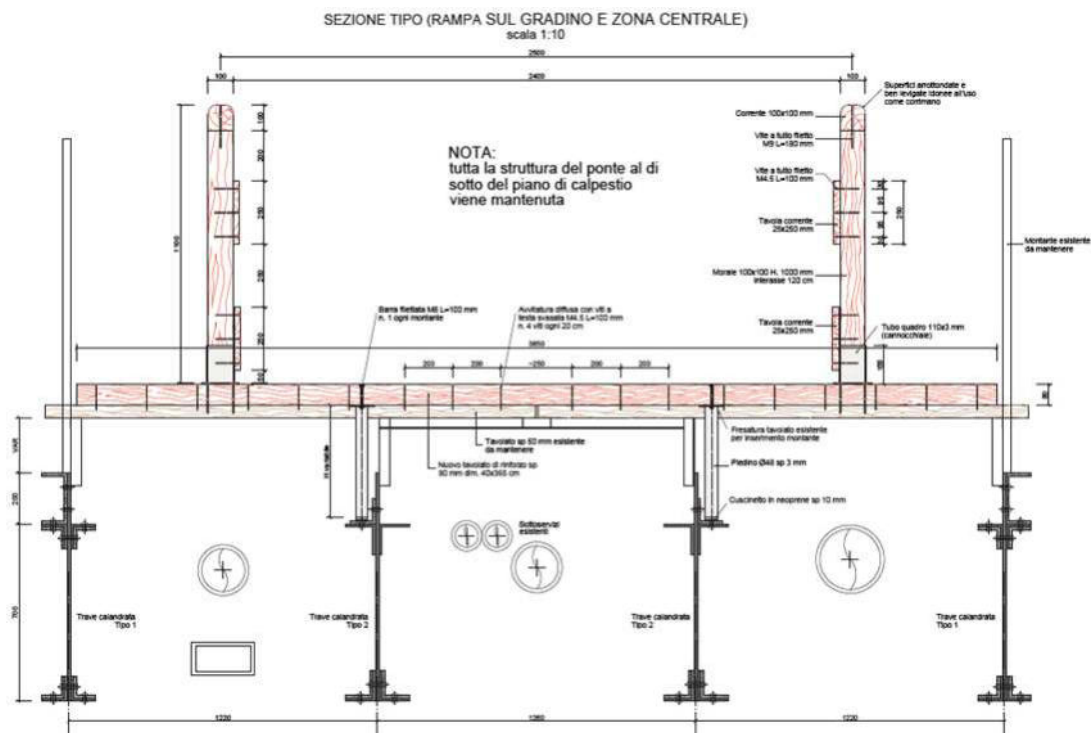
Parapetto e nuova pavimentazione per la messa in sicurezza temporanea
